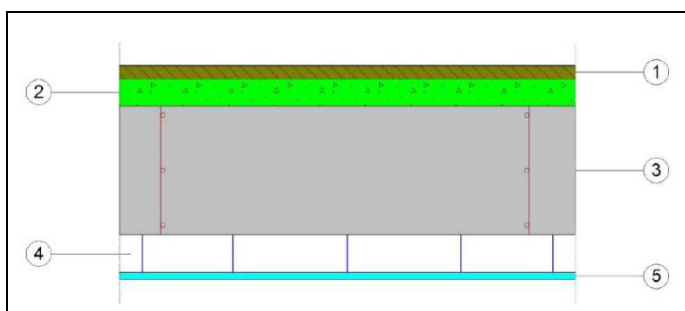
17 - Pedra Lioz nos halls dos elevadores
